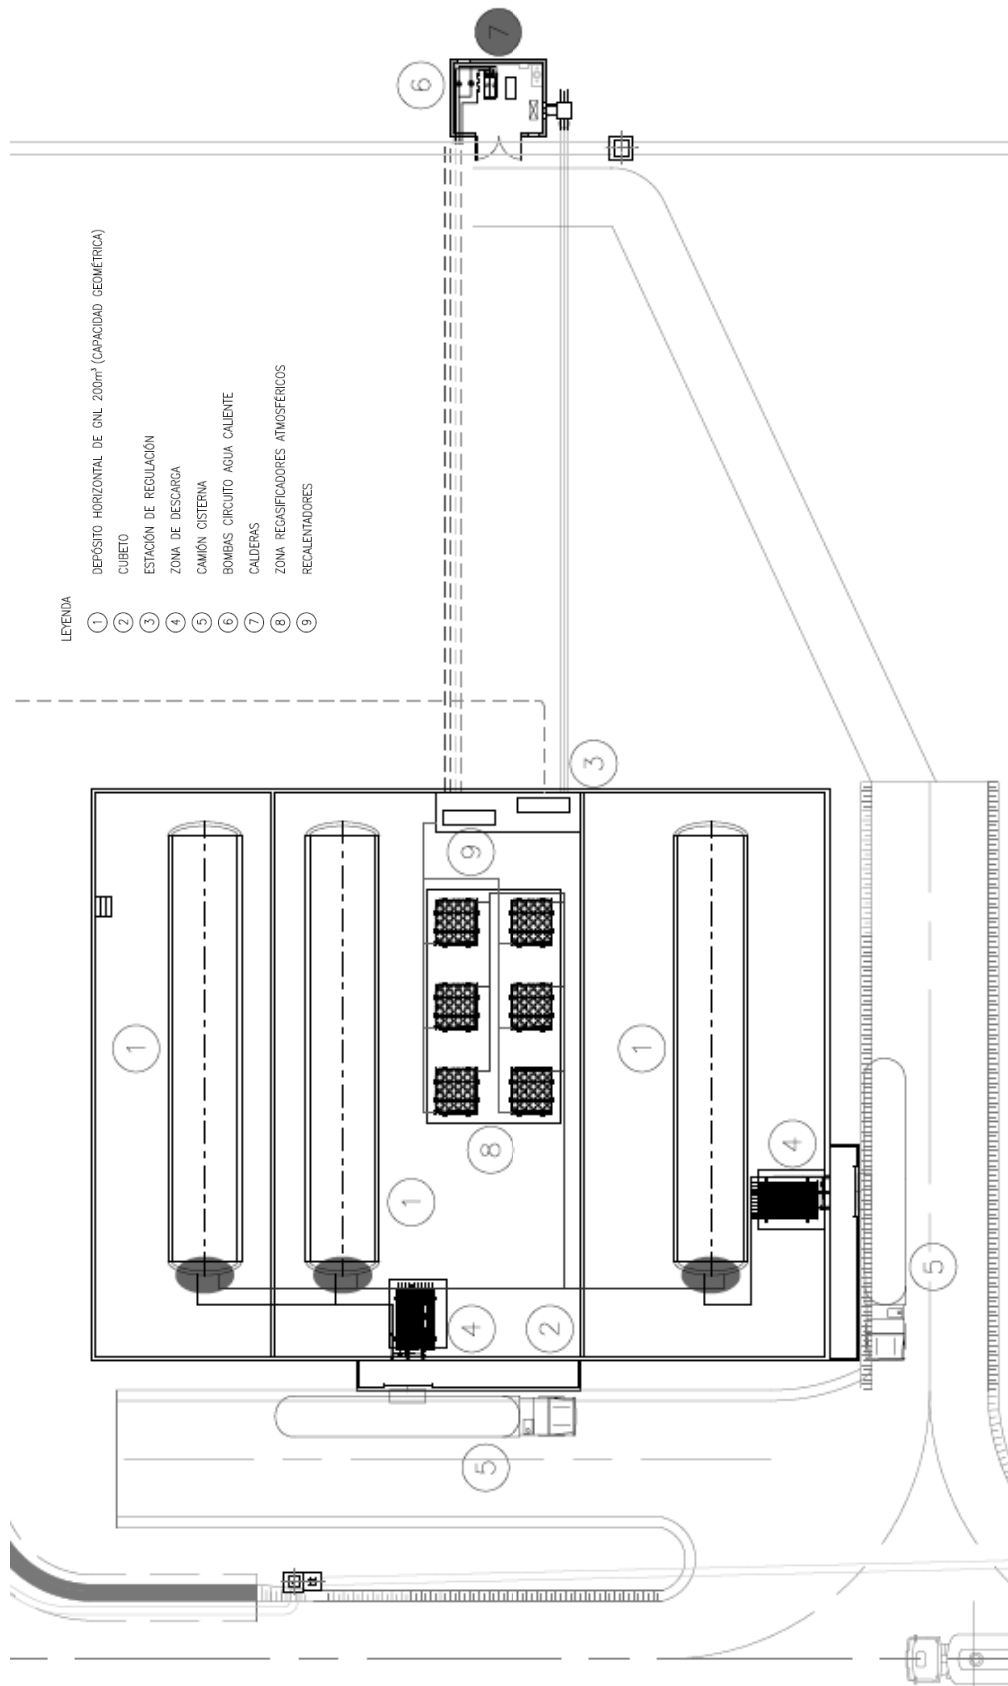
Plano en planta de instalaciones, infraestructuras y equipos.
